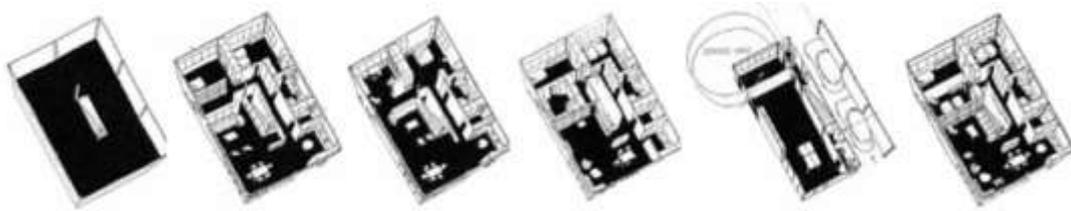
The New House 194x*: evolução da planta conforme as adições (SCHNEIDER & TILL, 2007).
